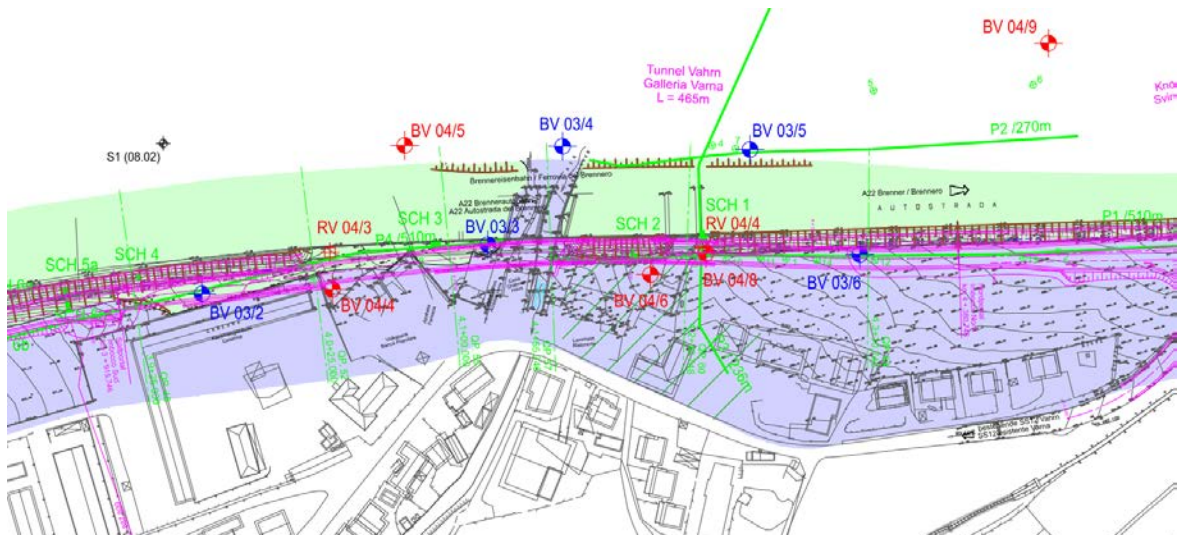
Auszug Lageplan mit Bodenaufschlüssen aus BV-U-603
